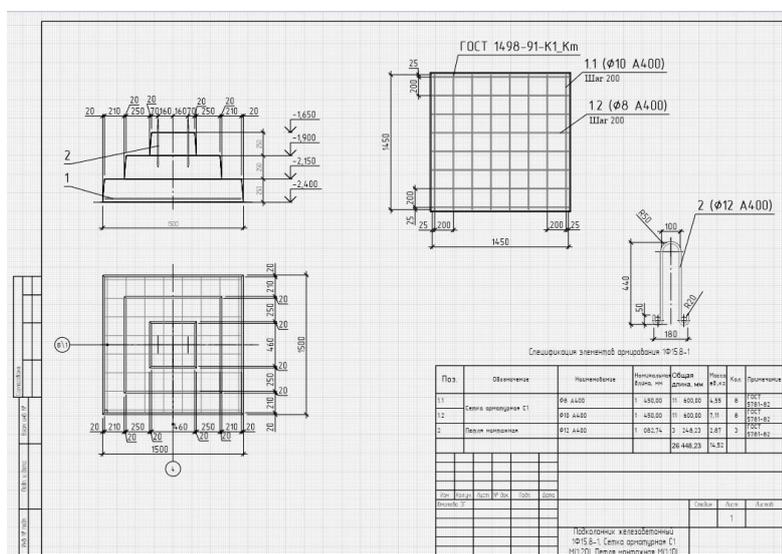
Фрагмент результата выполнения студентами межпредметного задания по разделу «Монолитные железобетонные конструкции» (армирование подколонника)
